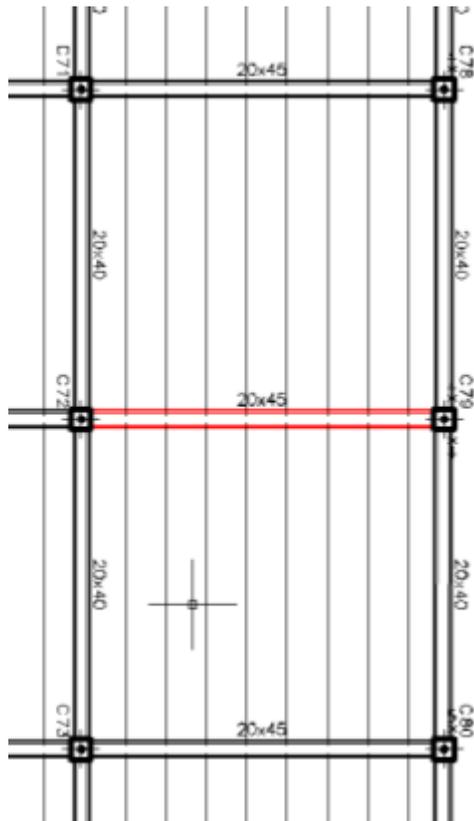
Elementos estructurales más solicitados (Vista lateral)
